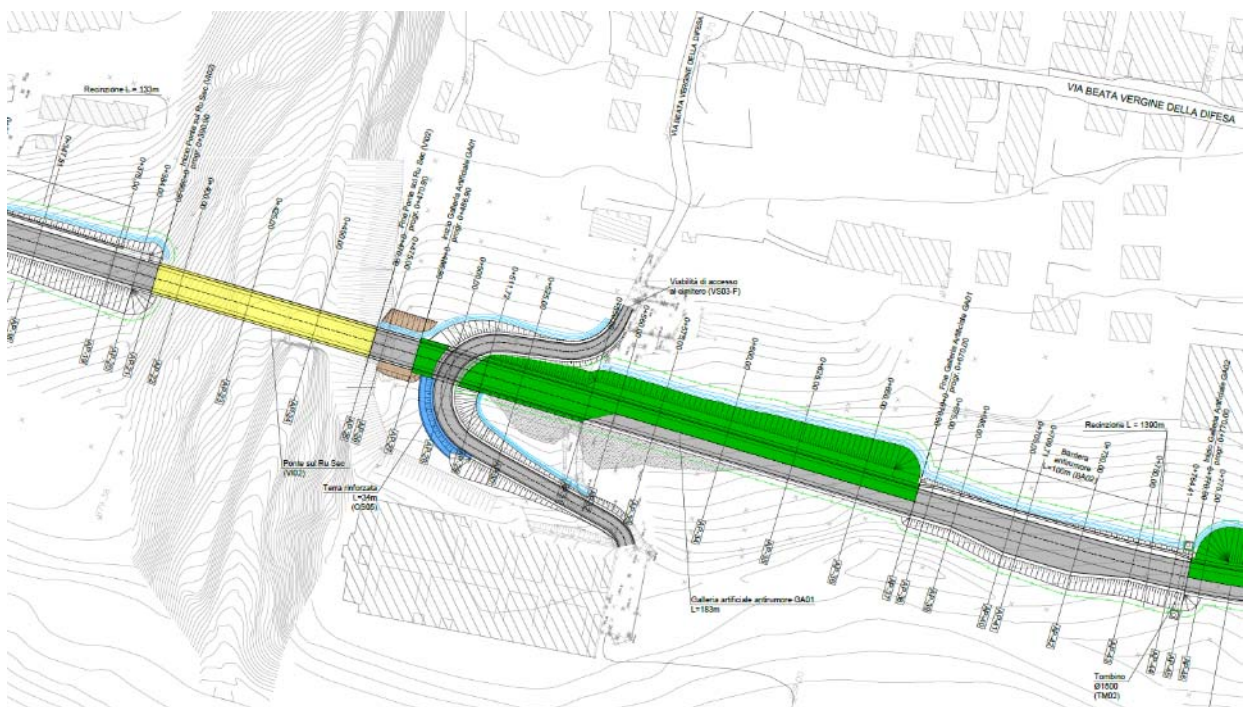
Stralcio planimetrico zona Ru Sec e GA01
